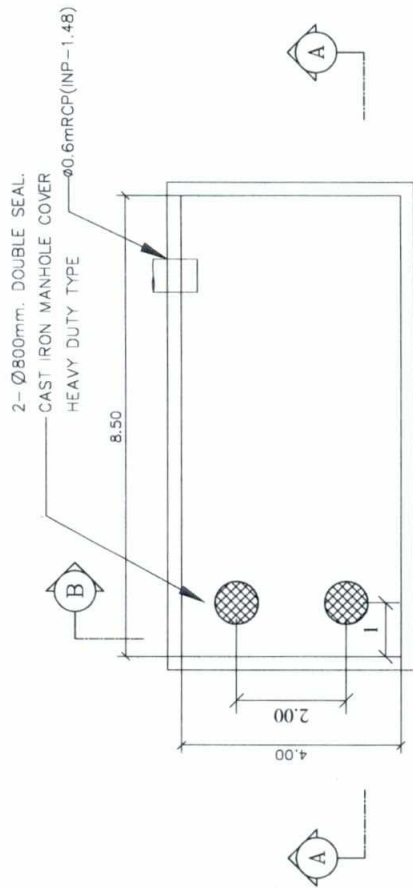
ผังระบระบายน้ำในโครงการ
